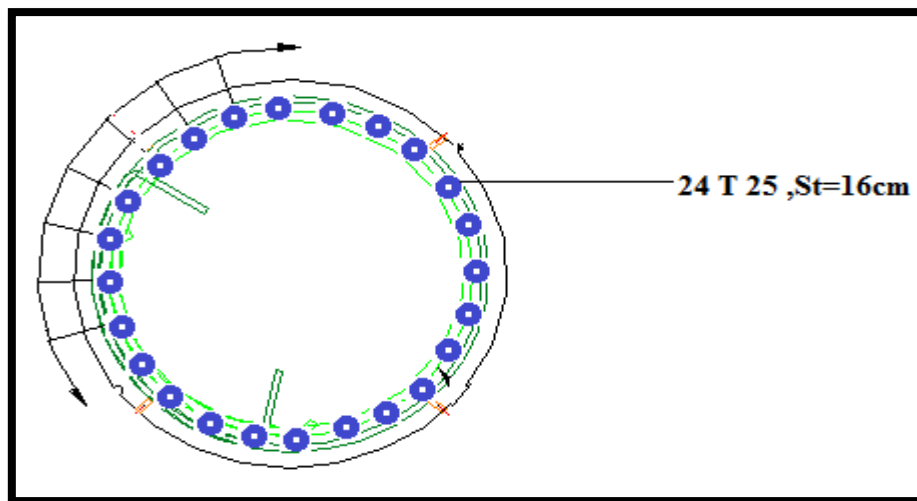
Schéma de ferrailage longitudinal (P3)
